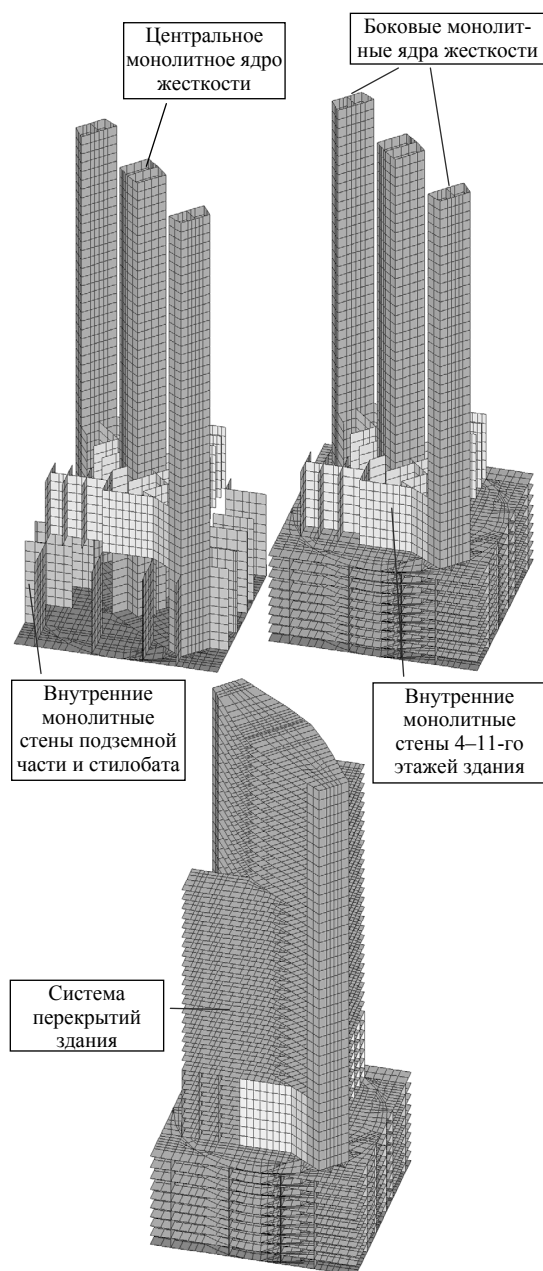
Конструктивная схема внутренних монолитных стен здания и перекрытий
